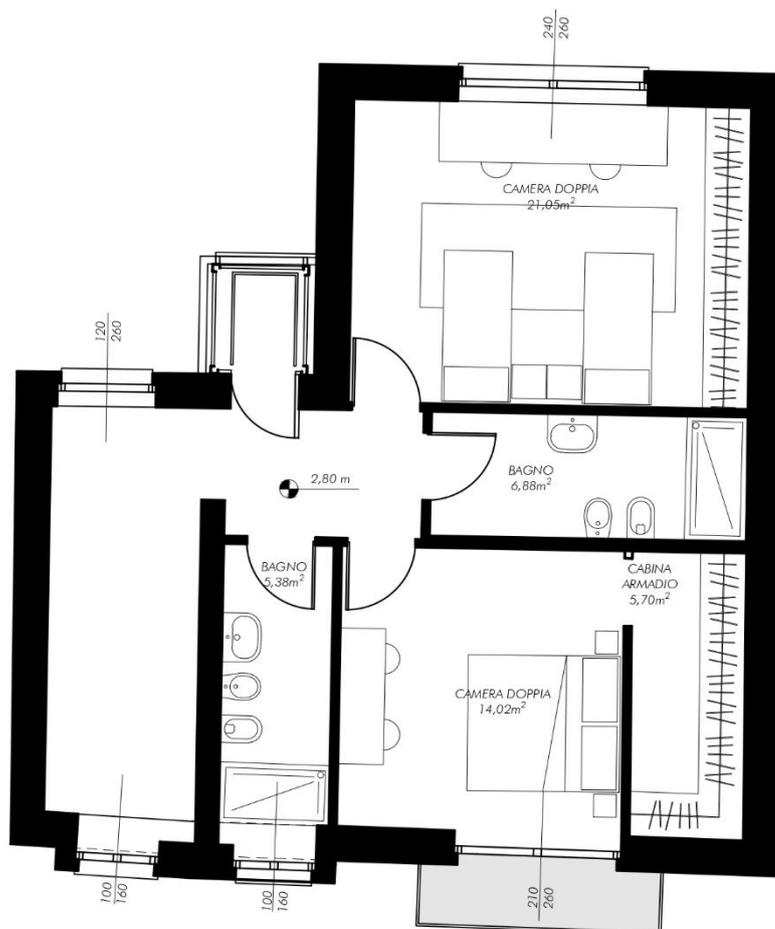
Alternativa progettuale Villa singola con due camere doppie
